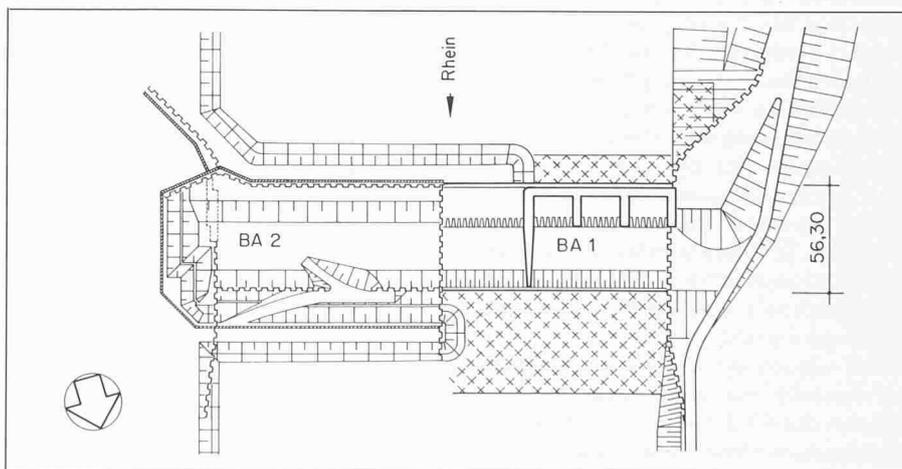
Lageplan mit Baugrube, 2. Bauabschnitt
